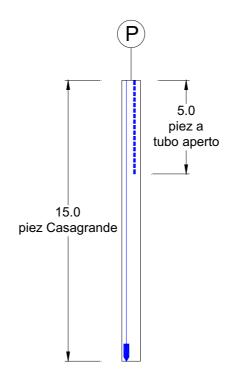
Schema installazione piezometri nella singola verticale Pi.
